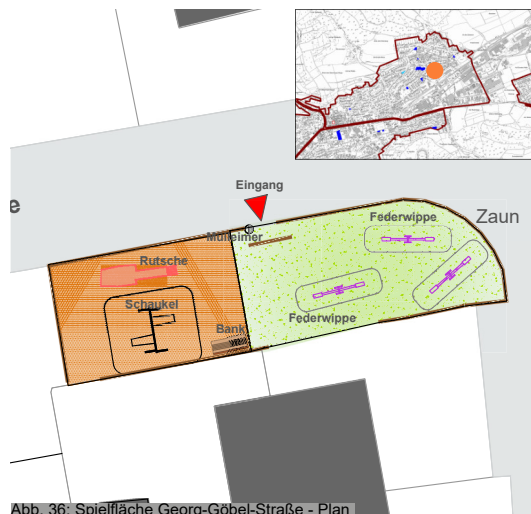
Spielfläche Georg-Göbel-Straße - Plan
